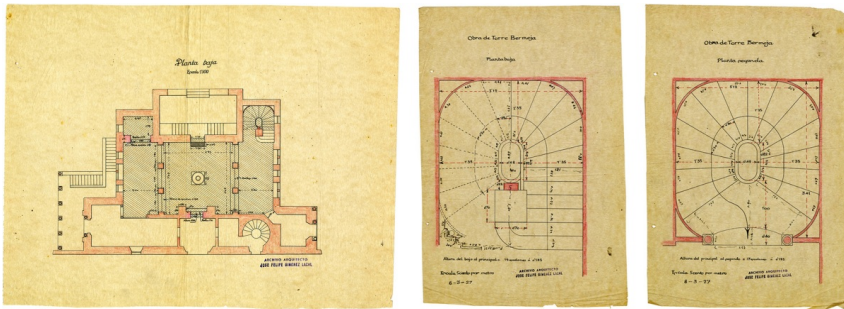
Giménez Lacal, J F, *Casa-estudio para D. José María Rodríguez-Acosta: «Planta baja», «Detalle de escalera. Planta baja», «Detalle de escalera. Planta segunda»*, 1927, AMG Y.
